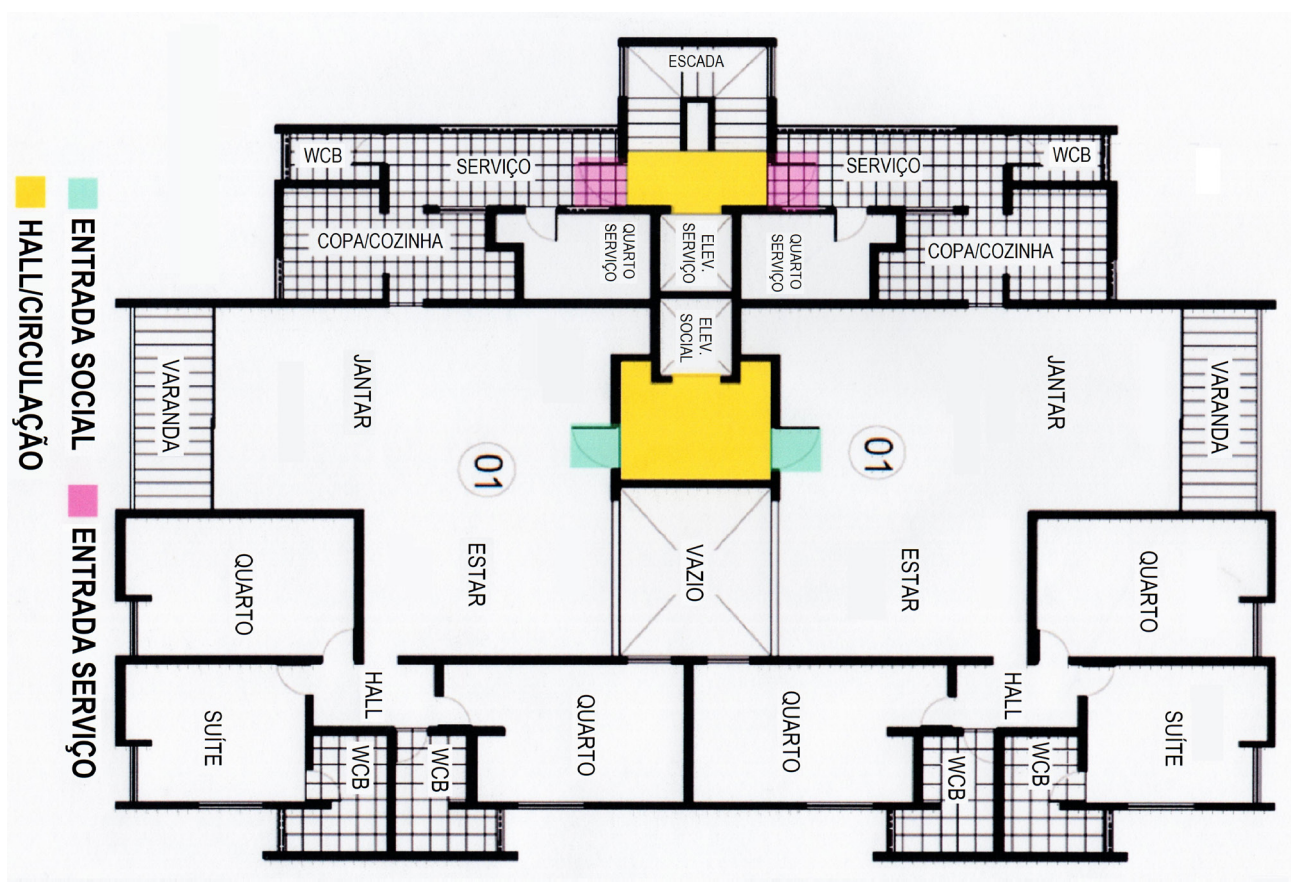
Planta baixa pavimento tipo do Edifício Tatiana (de 1975).
